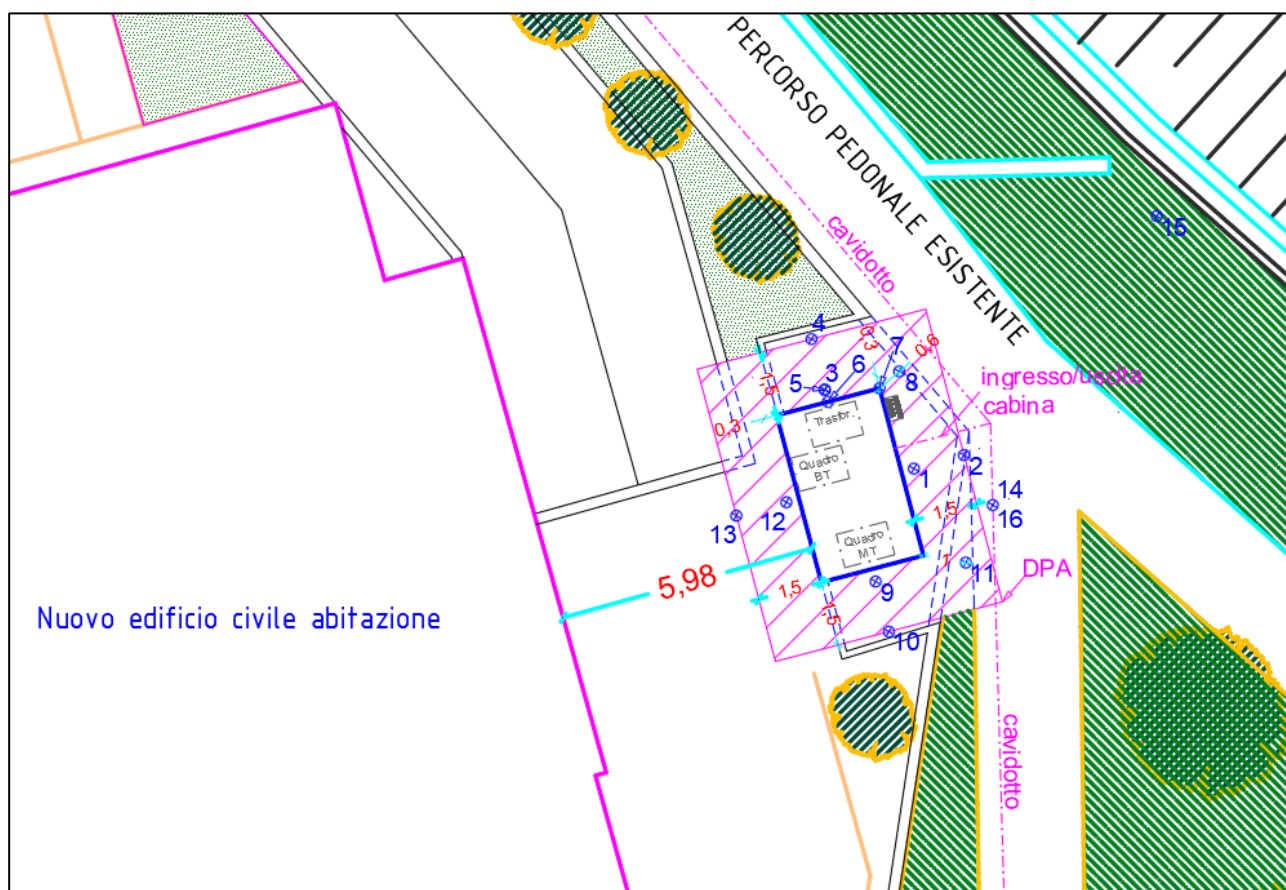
Planimetria dell'area con indicate le posizioni dei principali impianti, DPA e postazioni di indagine
